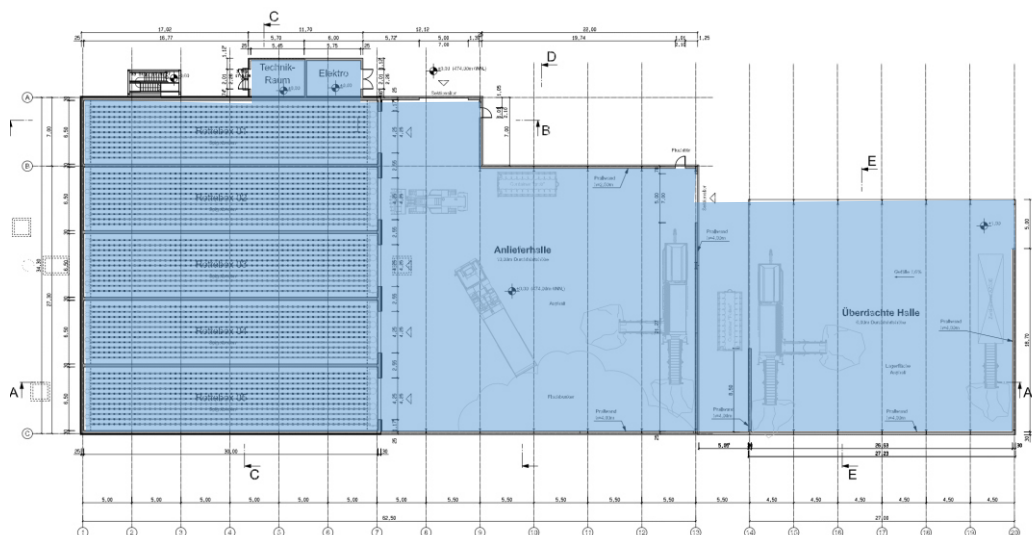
Schematische Darstellung der anrechenbaren und zusammenhängenden Brandbekämpfungsabschnittsfläche
